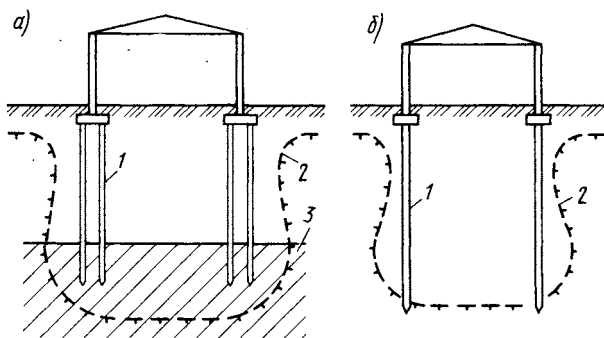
Свайные фундаменты при устройстве фундаментов по принципу II:
